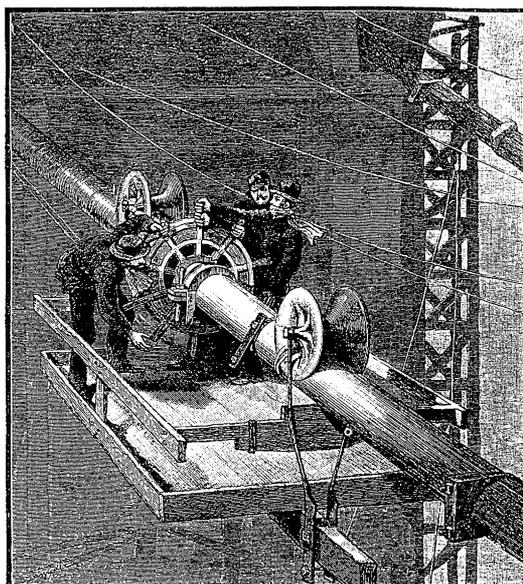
Brooklyn橋のケーブルラッピング施工状況
